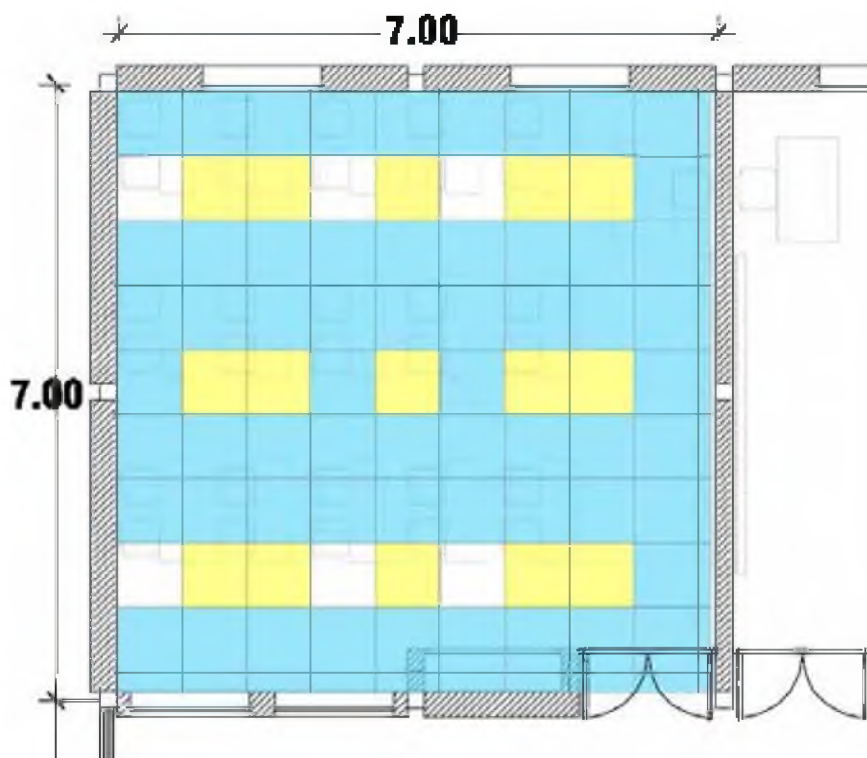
Planta para la ubicación de paneles fonoabsorbentes e iluminación.
